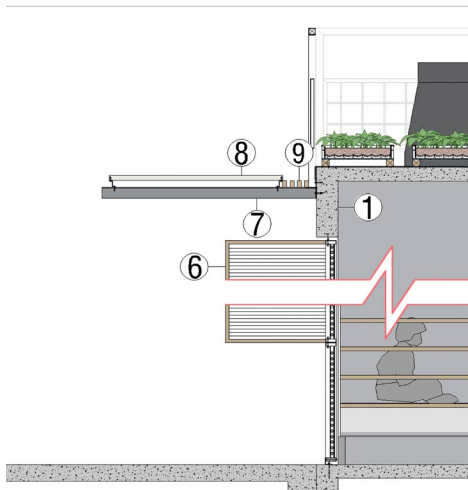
Corte por fachada. Fuente: Elaborado por los autores.
